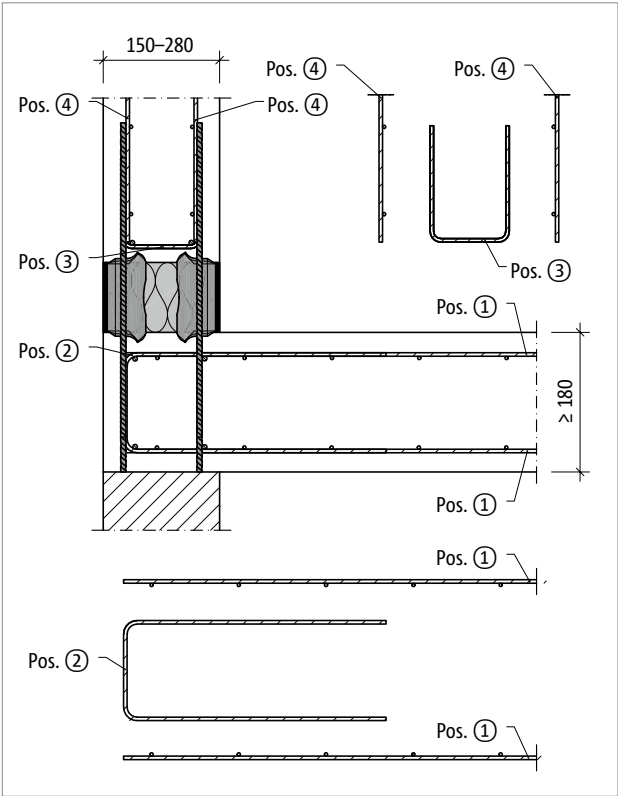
Schöck Isokorb® CXT Typ A: Bauseitige Bewehrung
